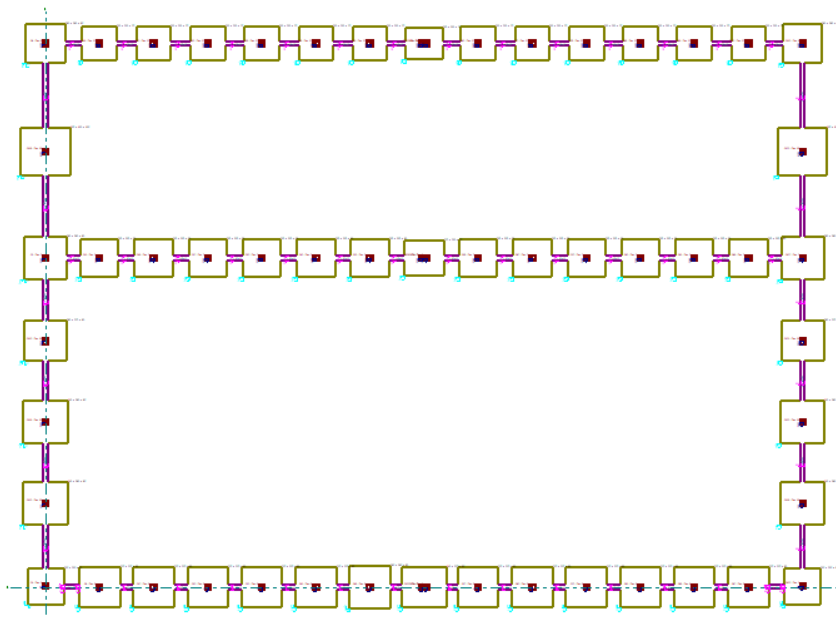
Vista en planta de cimentación. Fuente: CYPE 3D.
